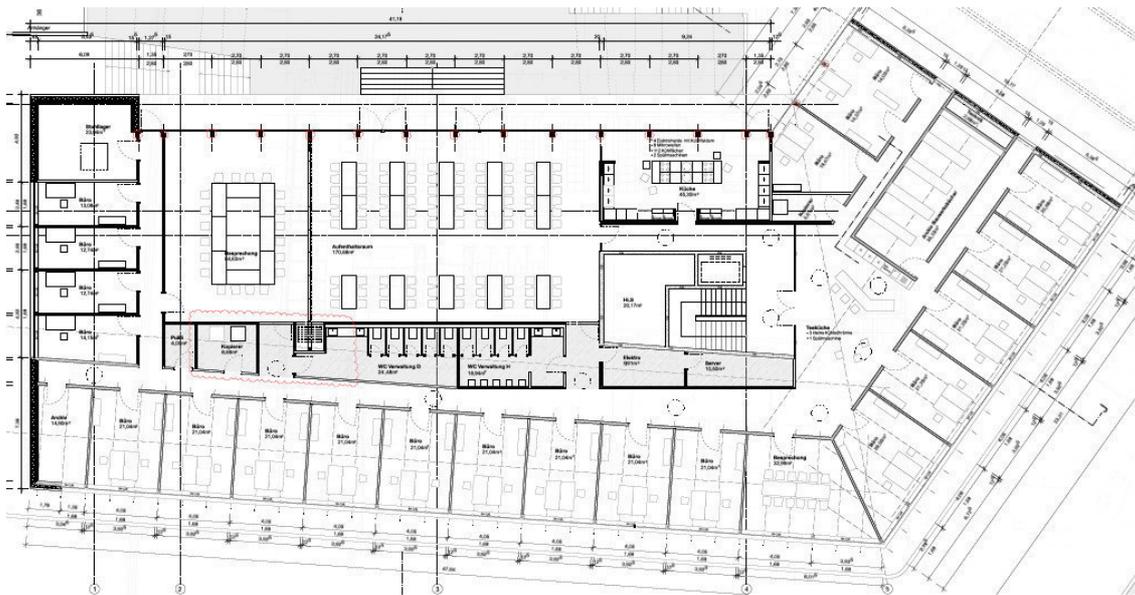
B1 Grundriss Obergeschoss
